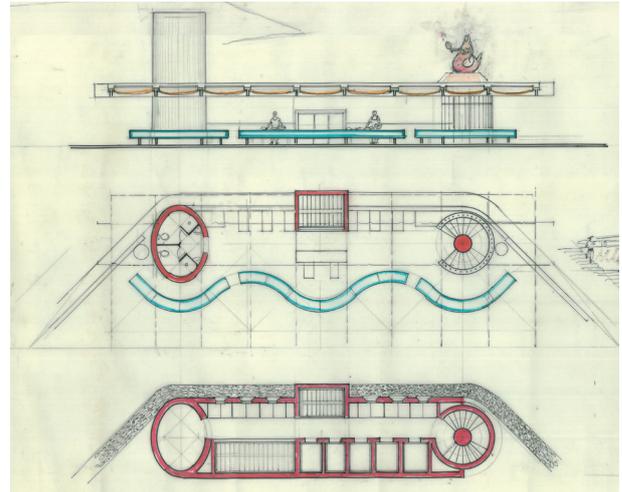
| Elevação e plantas dos pavimentos térreo e subsolo do mesmo projeto
